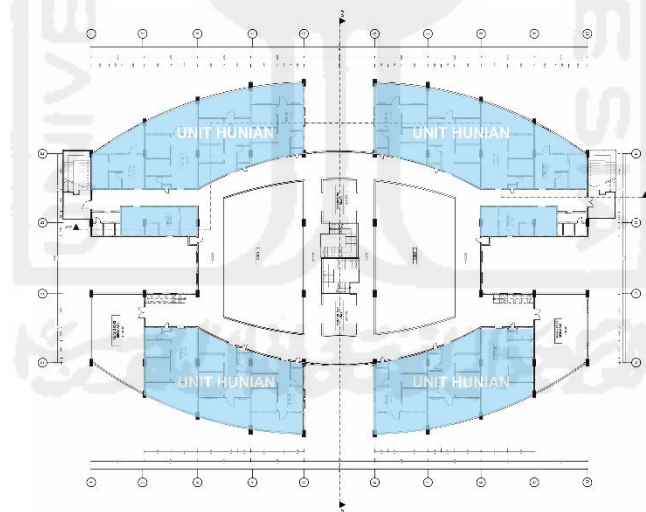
Rancangan Bentuk Bangunan Lantai 2
